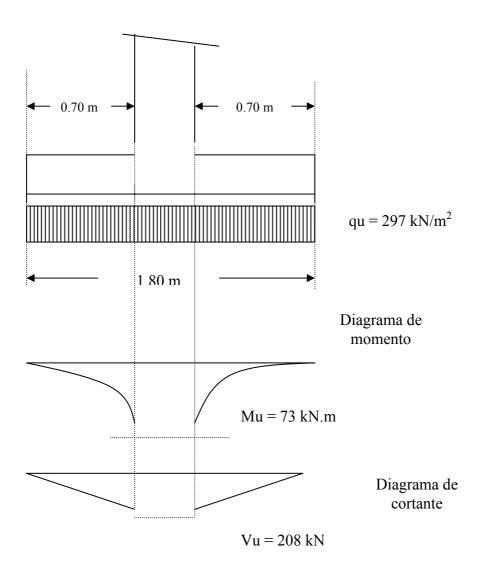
Cargas, momentos y cortantes en cimentación del ejemplo 12.1
